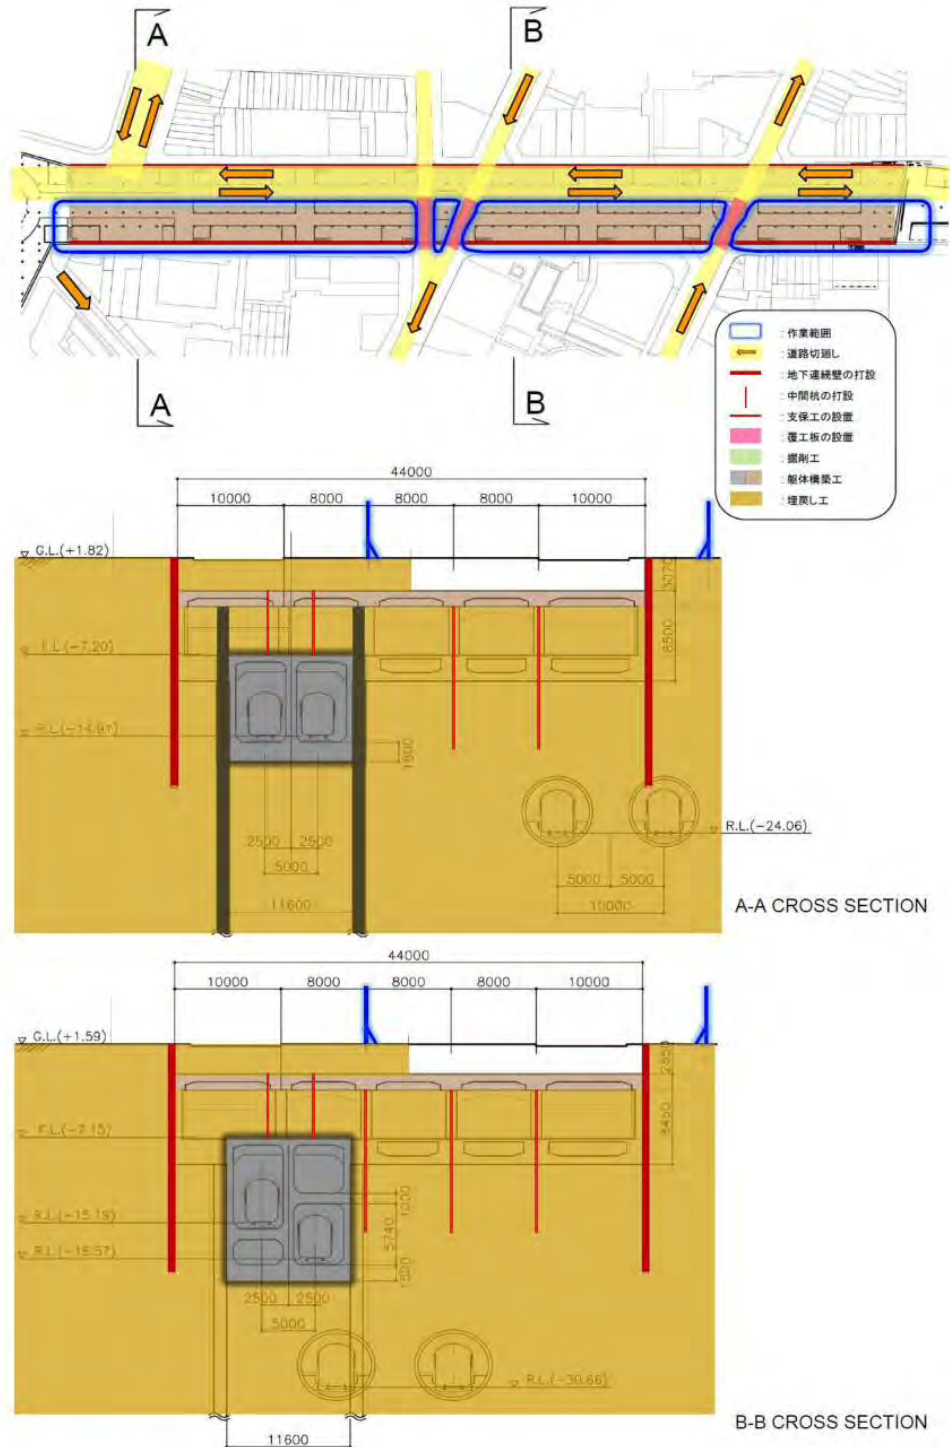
レロイ通り地区の都市鉄道 1 号線と地下街の施工手順図 (その 11/14)
